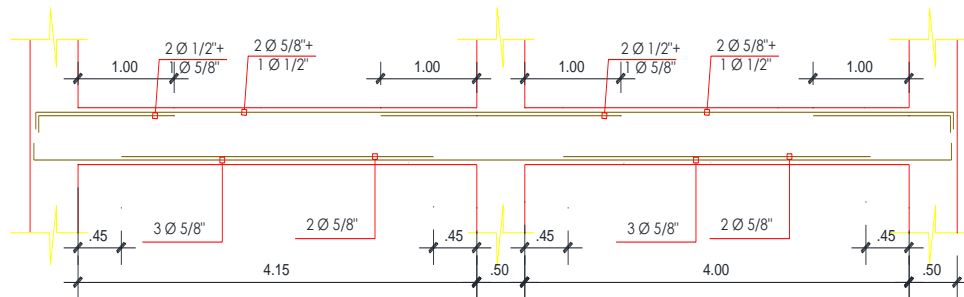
Longitud de las barras de refuerzo en vigas eje 6, entre A - C.
